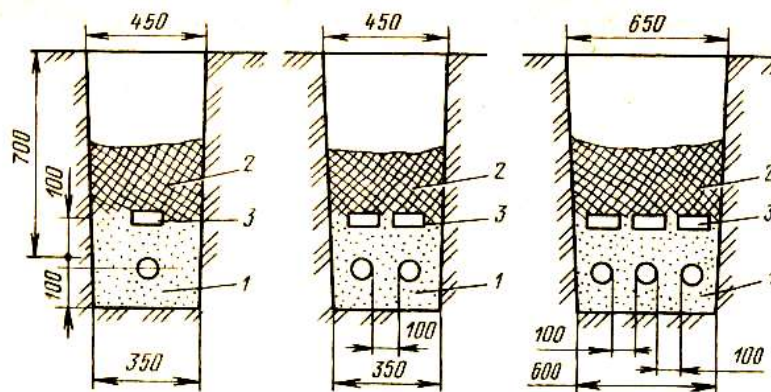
Разрез траншеи для прокладки кабеля напряжением до 10 кВ: 1 - песок или просеянная земля; 2 - грунтовая земля; 3 - кирпичи.
